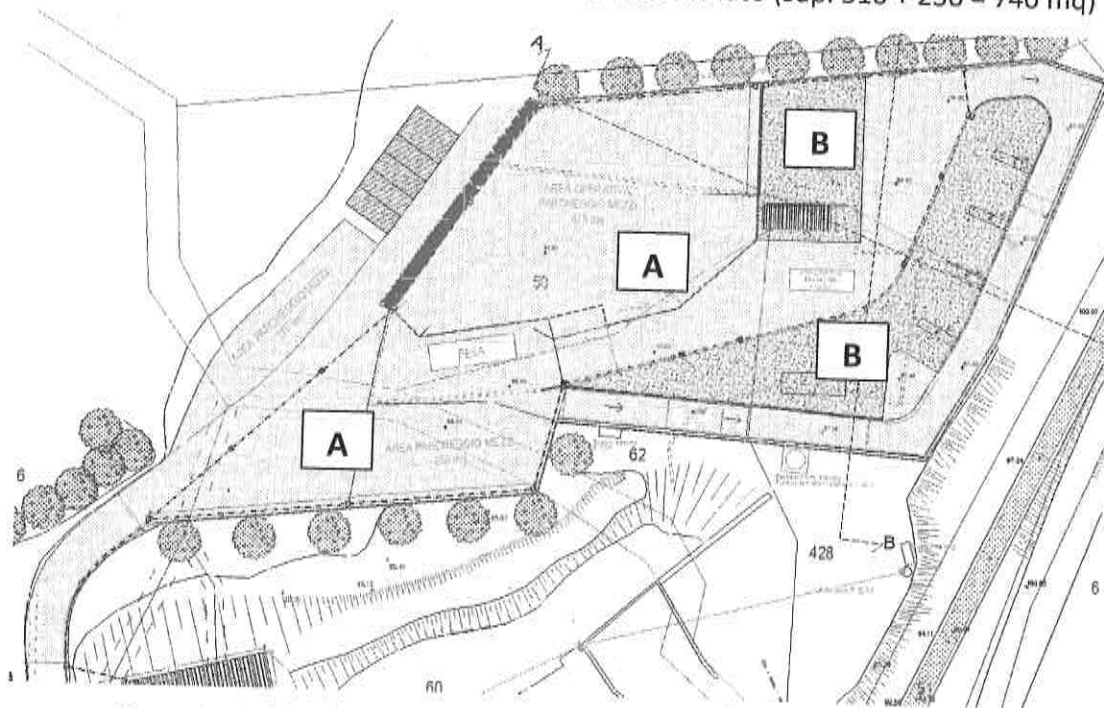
stralcio planimetria con indicazione delle superfici (da Disegno D02)
